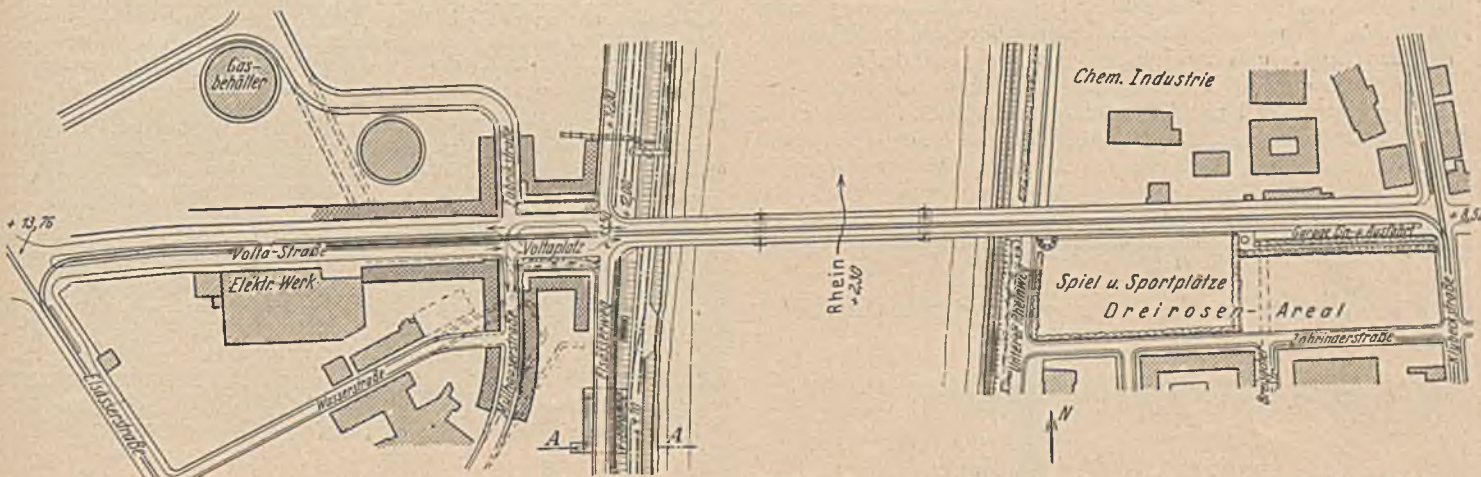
Lageplan mit Vorschlägen für die Ausgestaltung der beiderseitigen Rampen und Anschlüsse.
